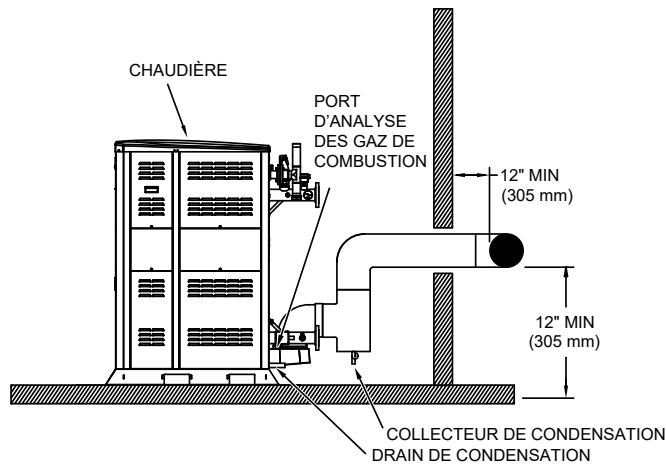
PVC/CPVC - Ventilation murale et horizontale
